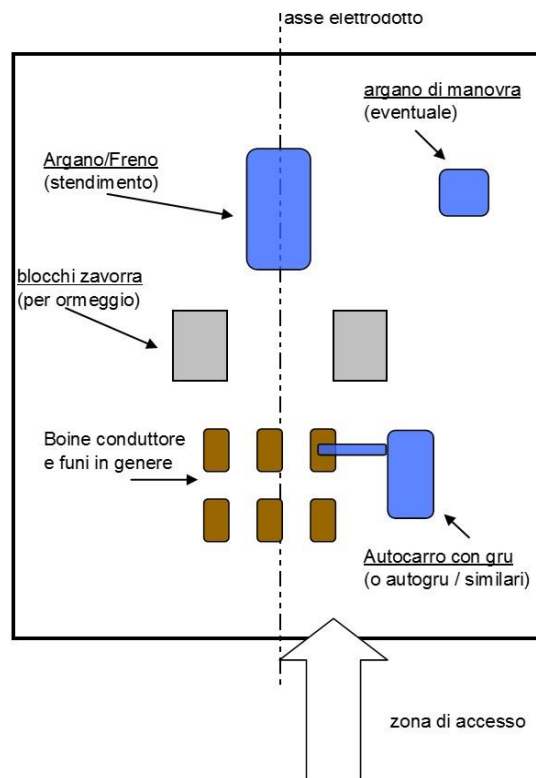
Planimetria dell'Area Sostegno (montaggio sostegno) - Planimetria dell'Area di linea - Tipologico
